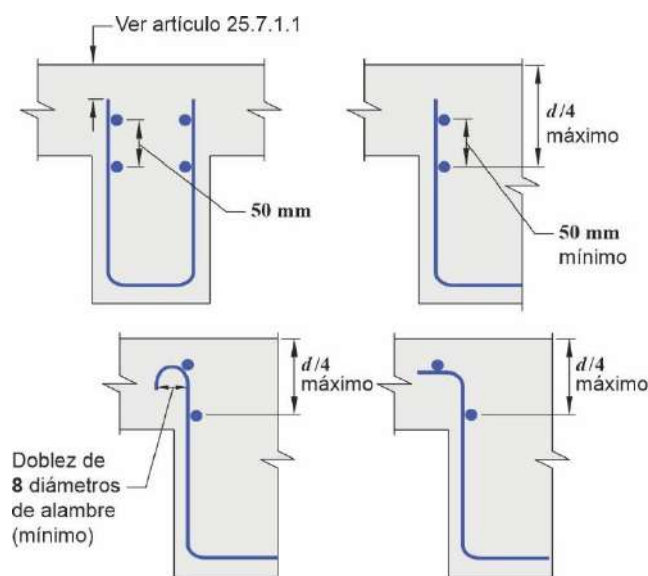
Anclajes de estribos en U de malla de acero soldada de alambres en la zona de compresión.
